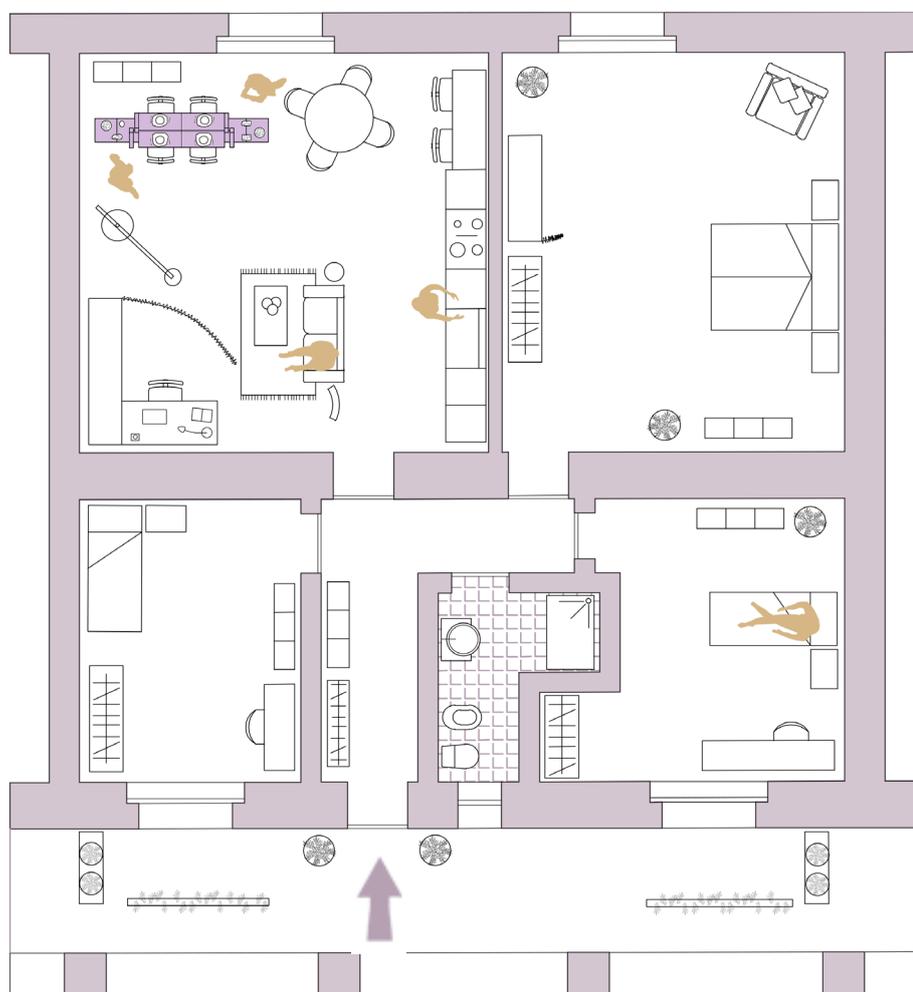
Rappresentazione planimetrica soluzione ambiente conviviale.
